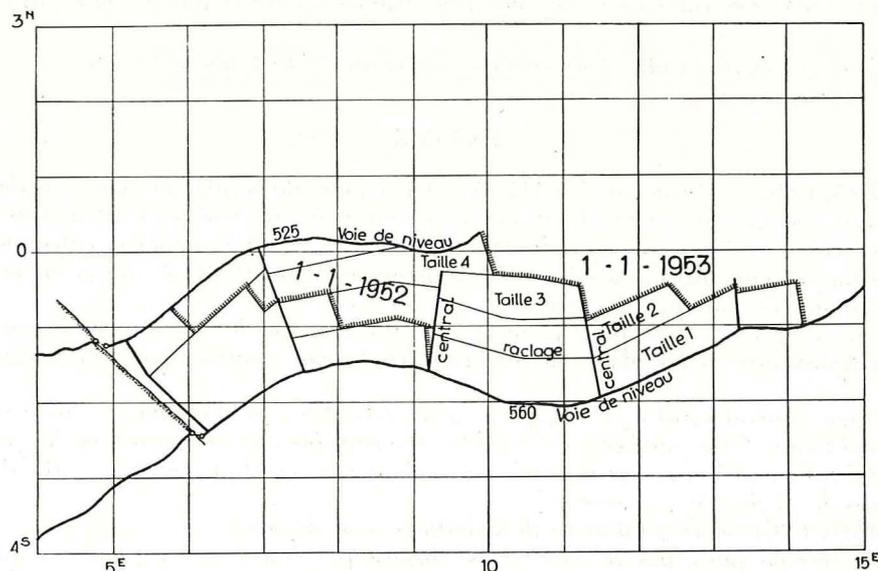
Chantier Beaujardin Est — Groupe Vallée 560-525 m.
